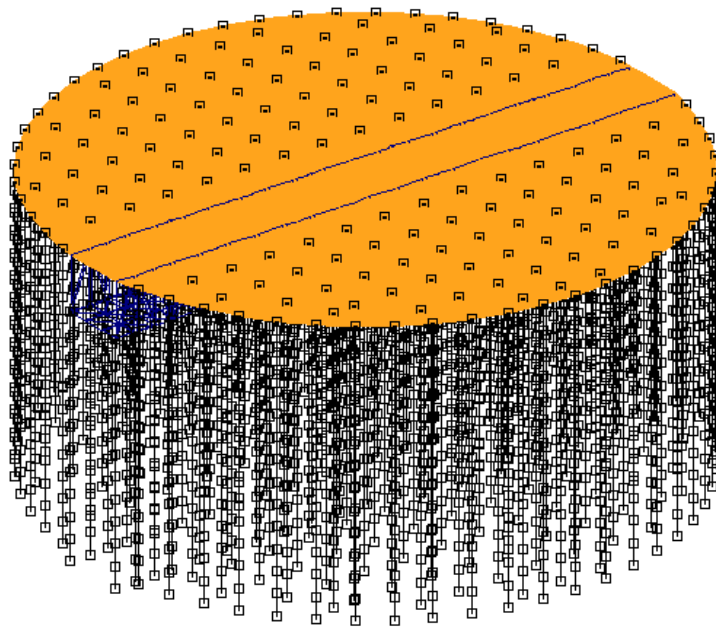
Розподілене навантаження на фундаментну плиту, кН/м<sup>2</sup>
